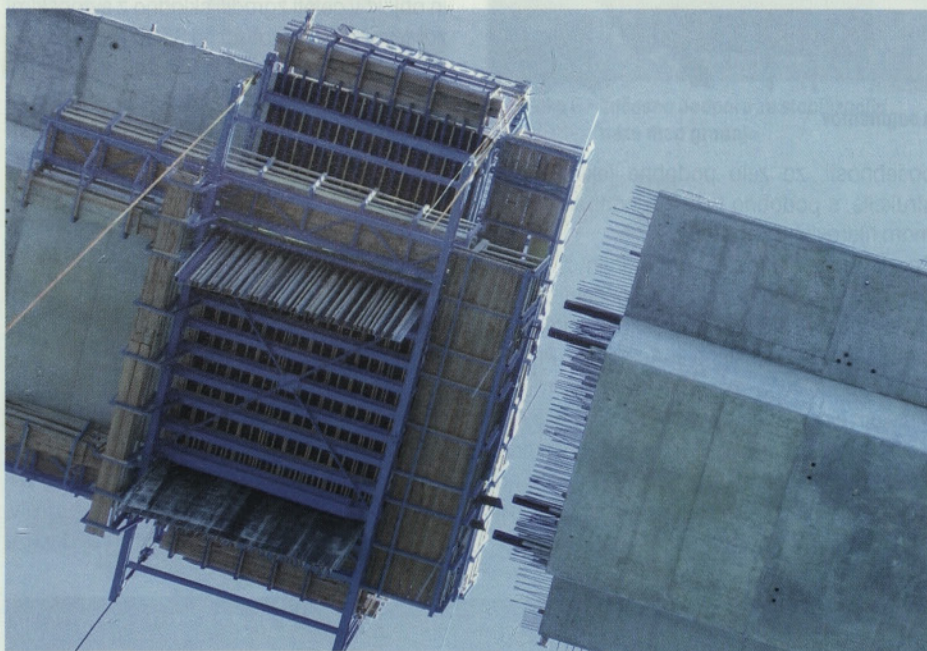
• Voziček Freyssinet je pod betonsko konstrukcijo
